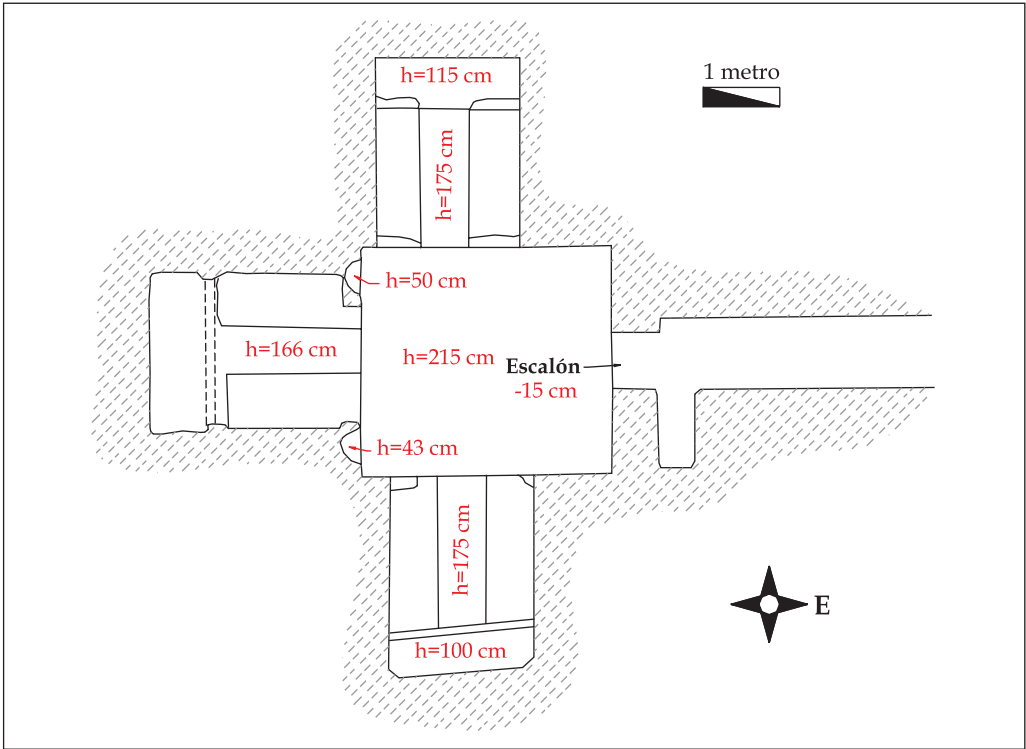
Planta del hipogeo HOR/1. Tipo 3
